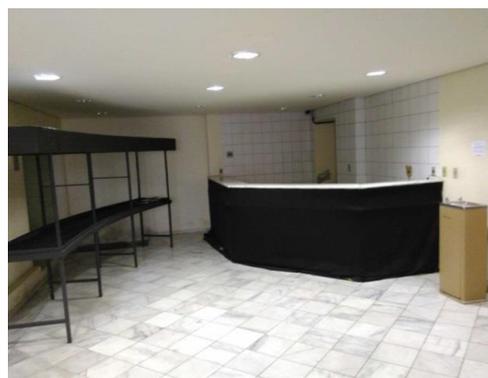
Área de circulação vista para o bar. Fonte dos autores.
